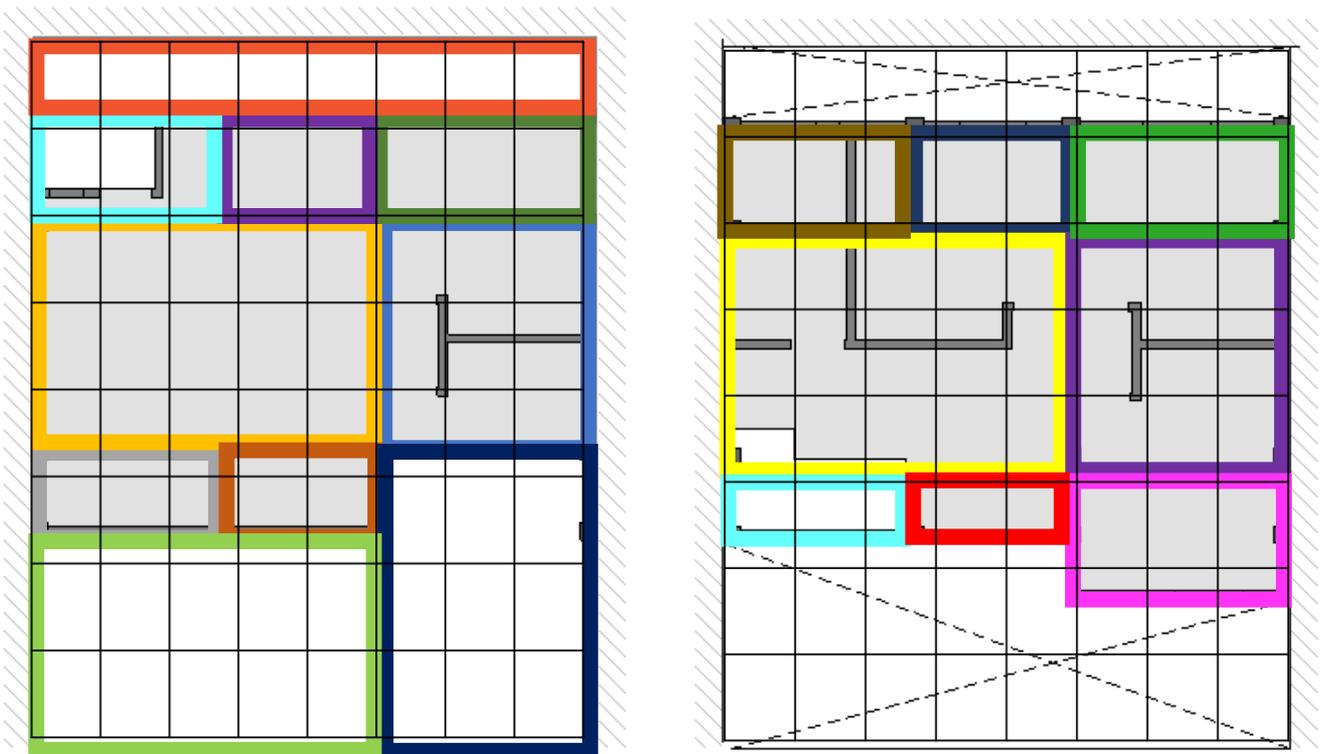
Planta arquitectónica modulada. Diseñada por Katia M. Garibay Jacobo
